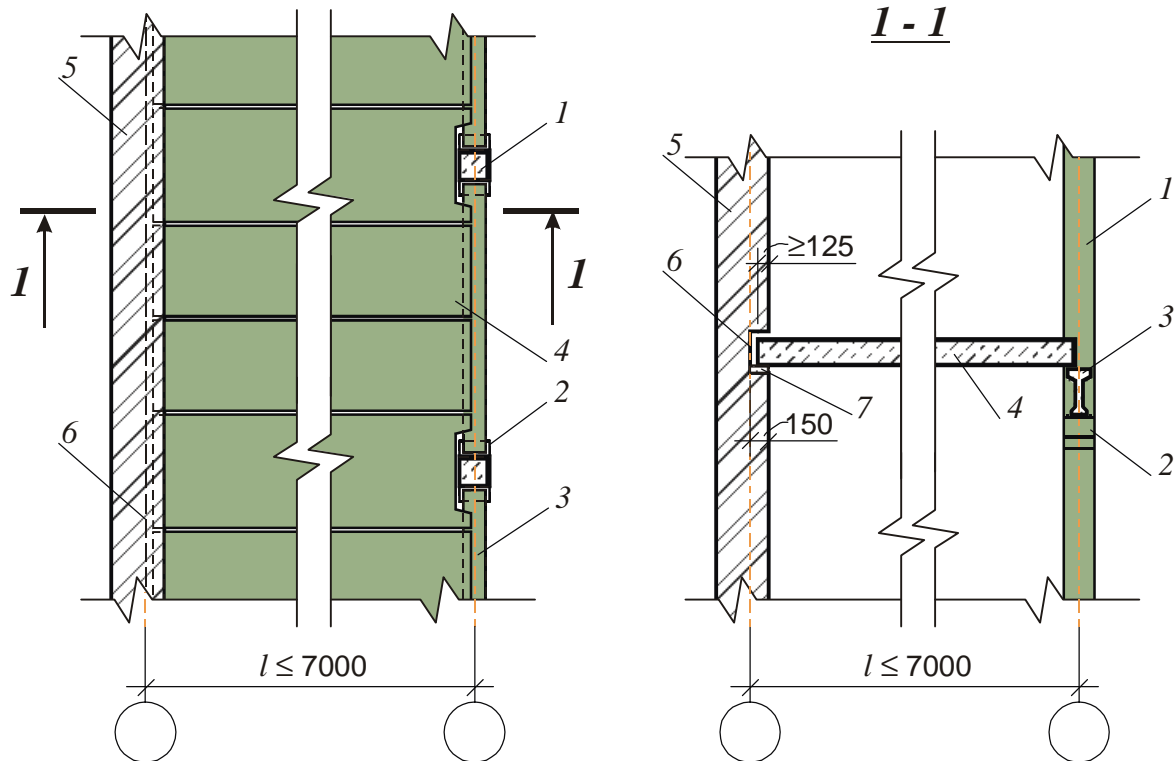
Конструкция перекрытия с неполным внутренним железобетонным каркасом:
